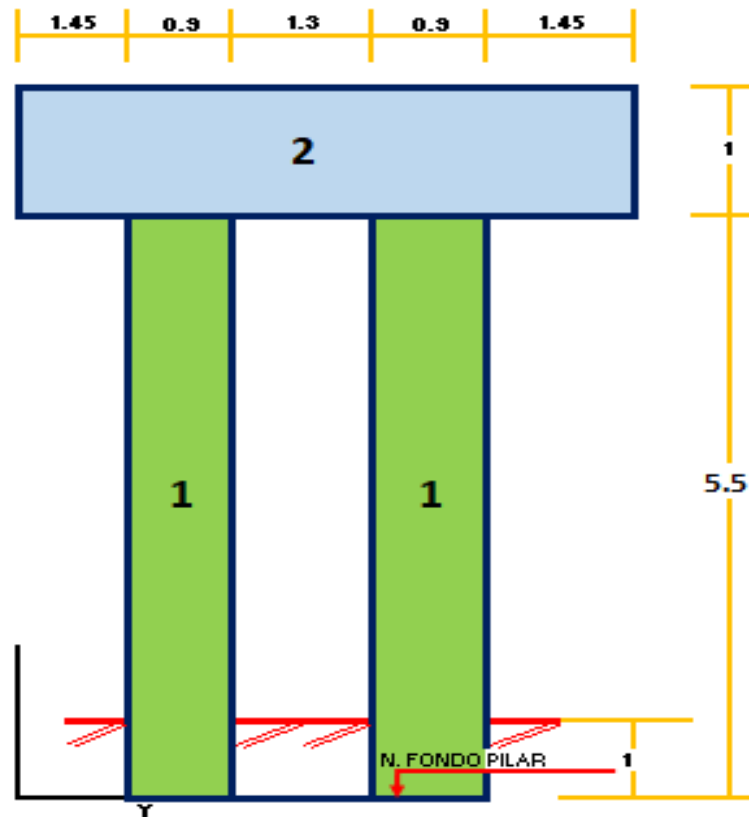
SECCION PILAR-FUENTE: ELABORACION PROPIA
